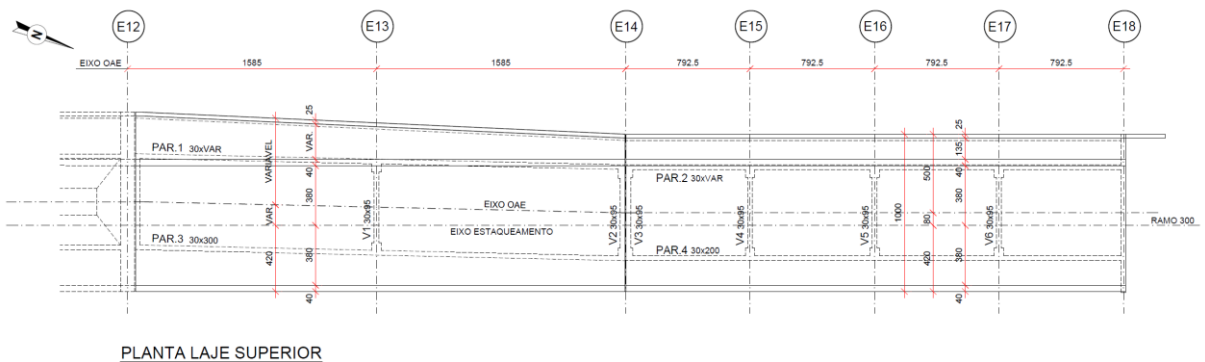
RAMO 300 - PLANTA ENCONTRO ESTRUTURADO (EIXOS E12 A E18)
